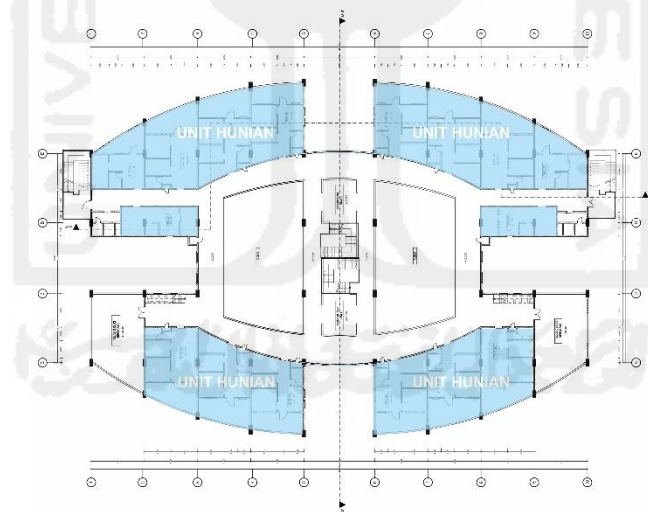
Rancangan Bentuk Bangunan Lantai 2
